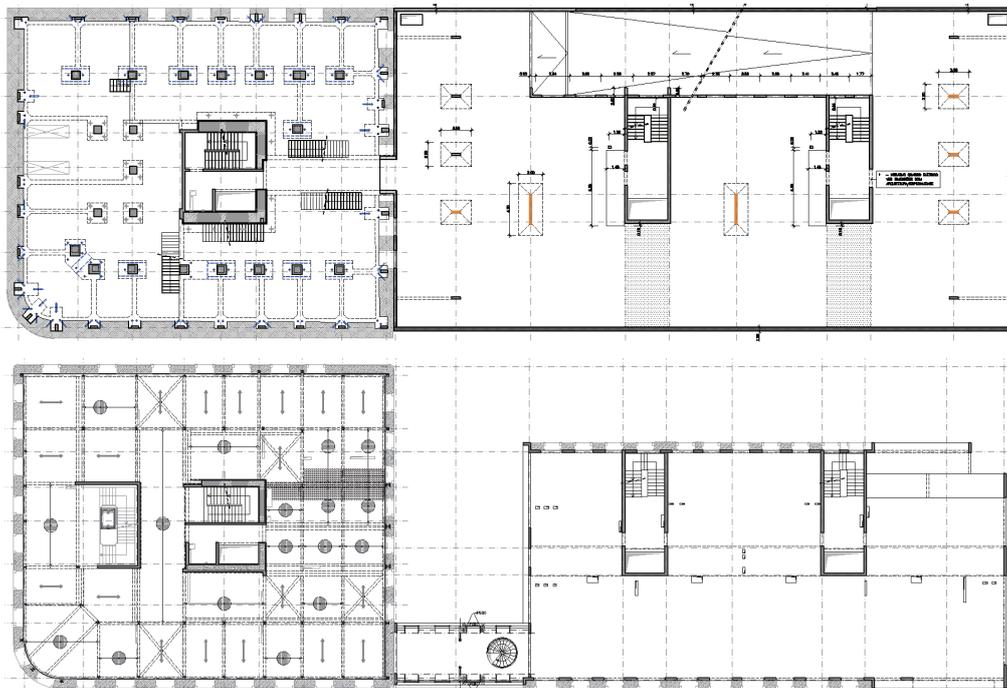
Plantas – tipo da solução estrutural adotada (piso enterrado, em cima, e piso elevado, em baixo)
